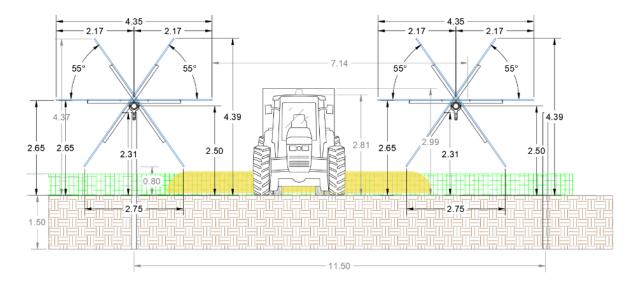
dettaglio sulle dimensioni dell'impianto rispetto ai mezzi utilizzati
